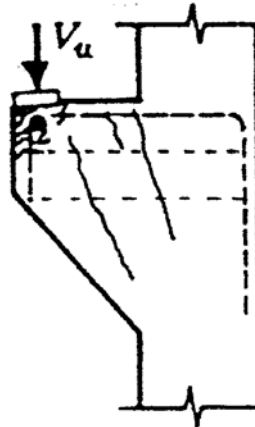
Ruptura por esmagamento localizado do concreto sob placa de apoio (MACHADO 1998).
